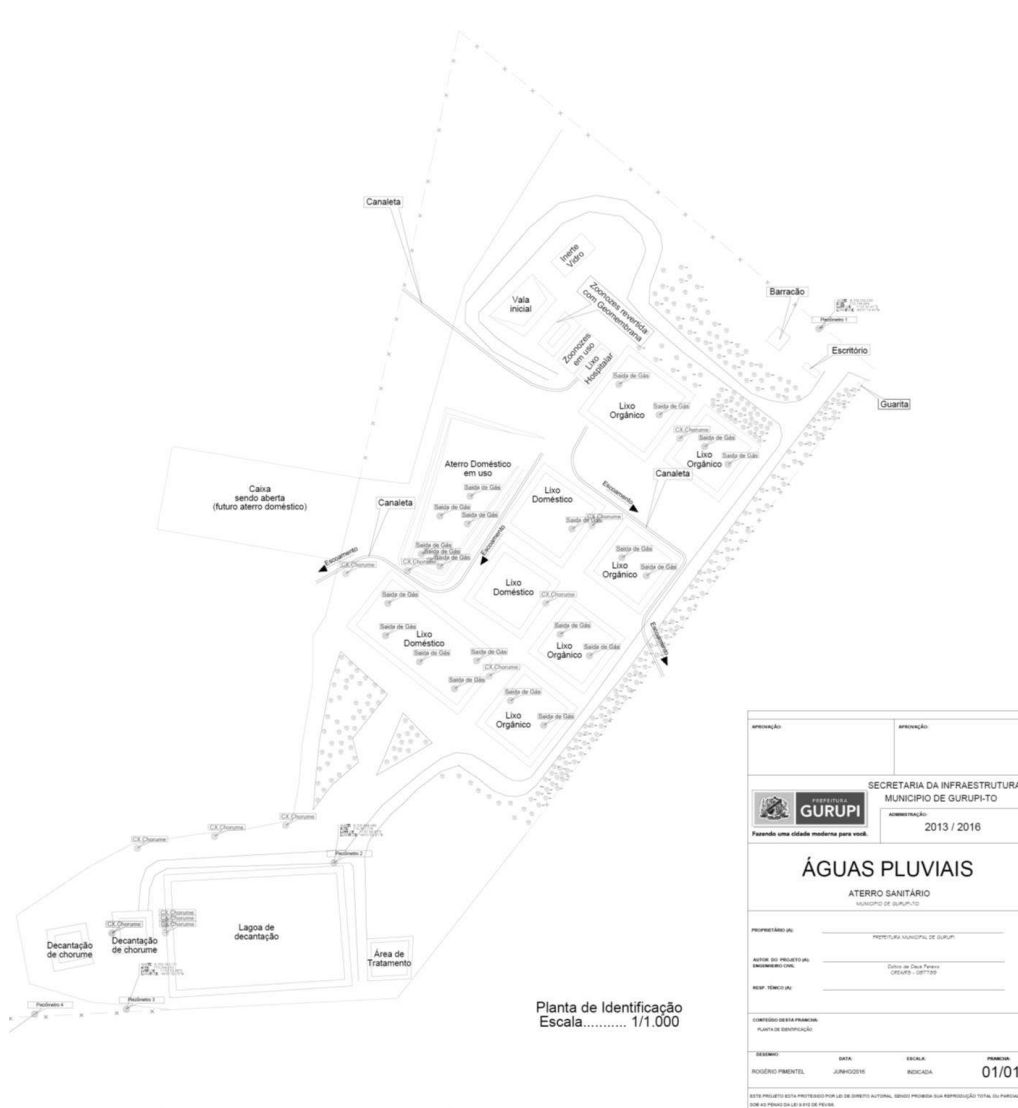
Sistema de Drenagem Pluvial no ASMG – Projeto inicial.
